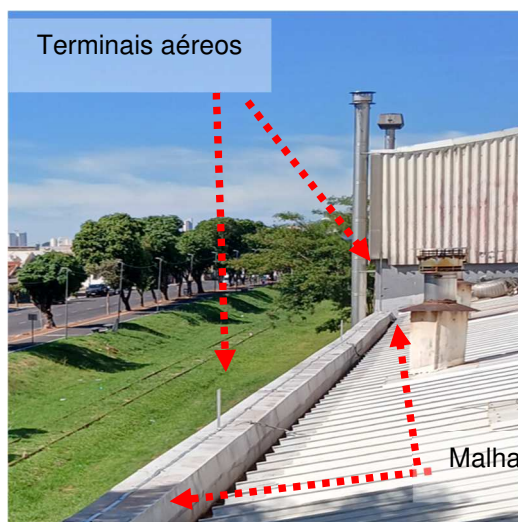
e 139: Malha captora construída em perfil de alumínio secção #70mm².
